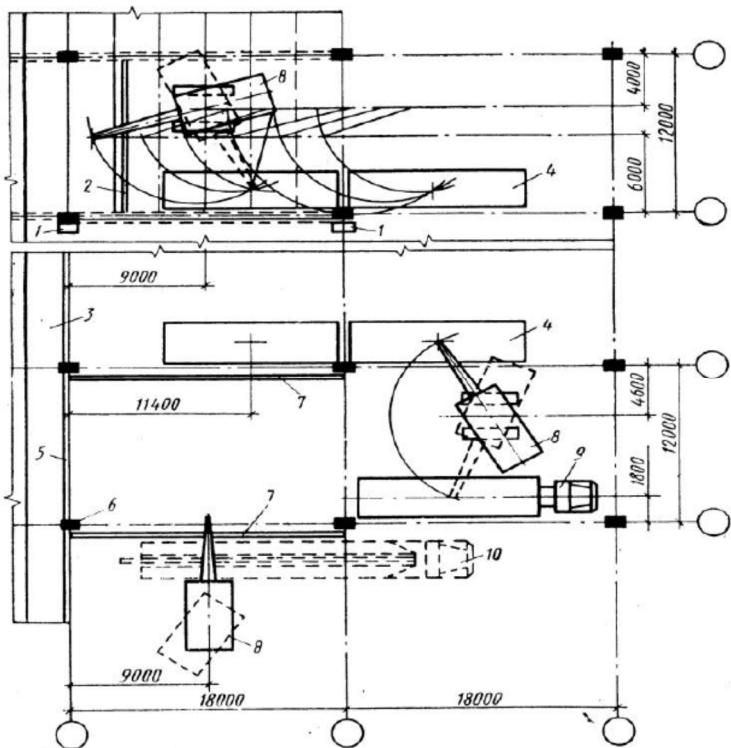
Схема выгрузки, раскладки элементов и монтажа покрытия в пролетах 18м поперечным методом: 1 - телескопическая вышка; 2- инвентарная распорка; 3 - смонтированное покрытие; 4 - штабель плит; 5 - временное ограждение; 6 - колонна; 7 - стропильная ферма; 8 - кран; 9 - плитовоз; 10 - фермовоз.
